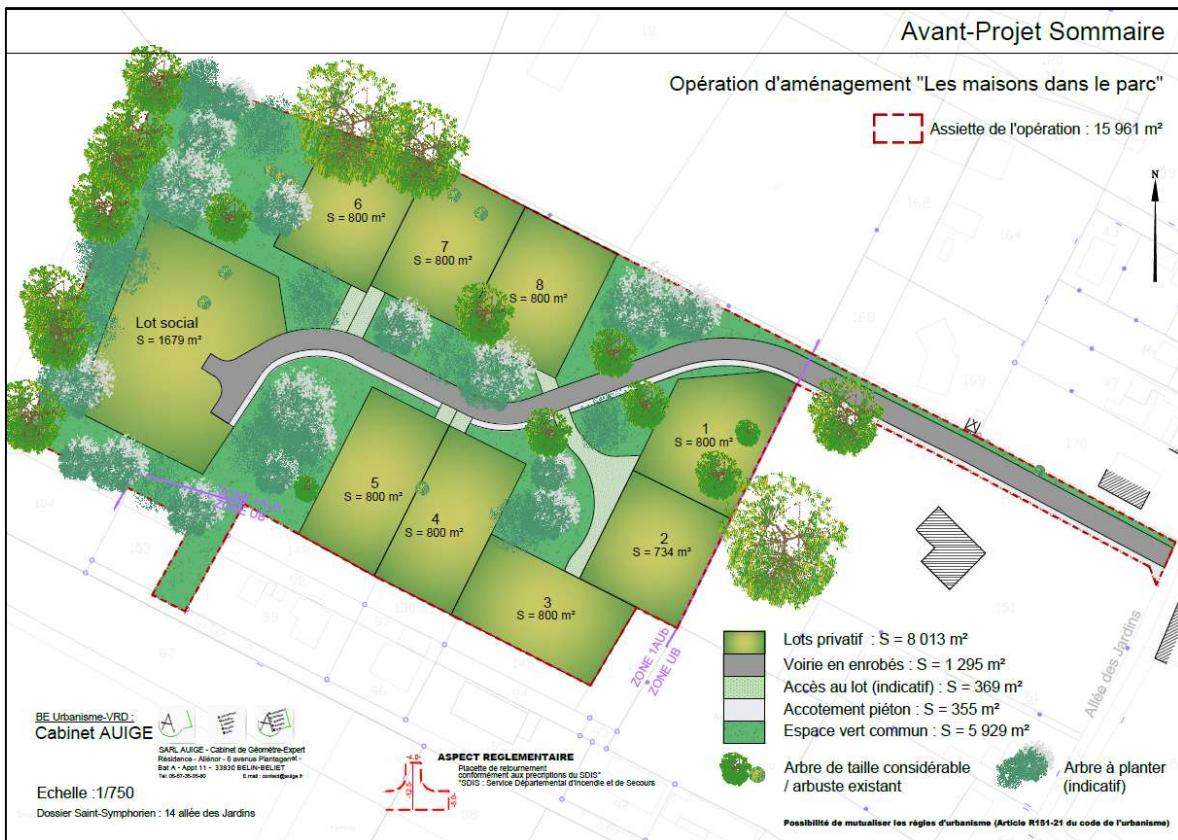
Plan d'avant-projet sommaire (Source : Cabinet AUIGE)
